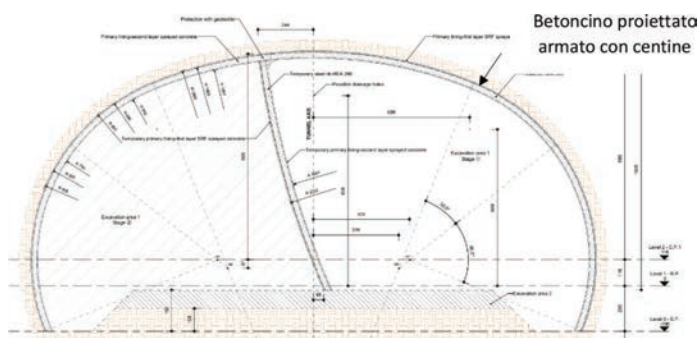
Sezione di scavo canna TU3 (Sezione EX-3).
